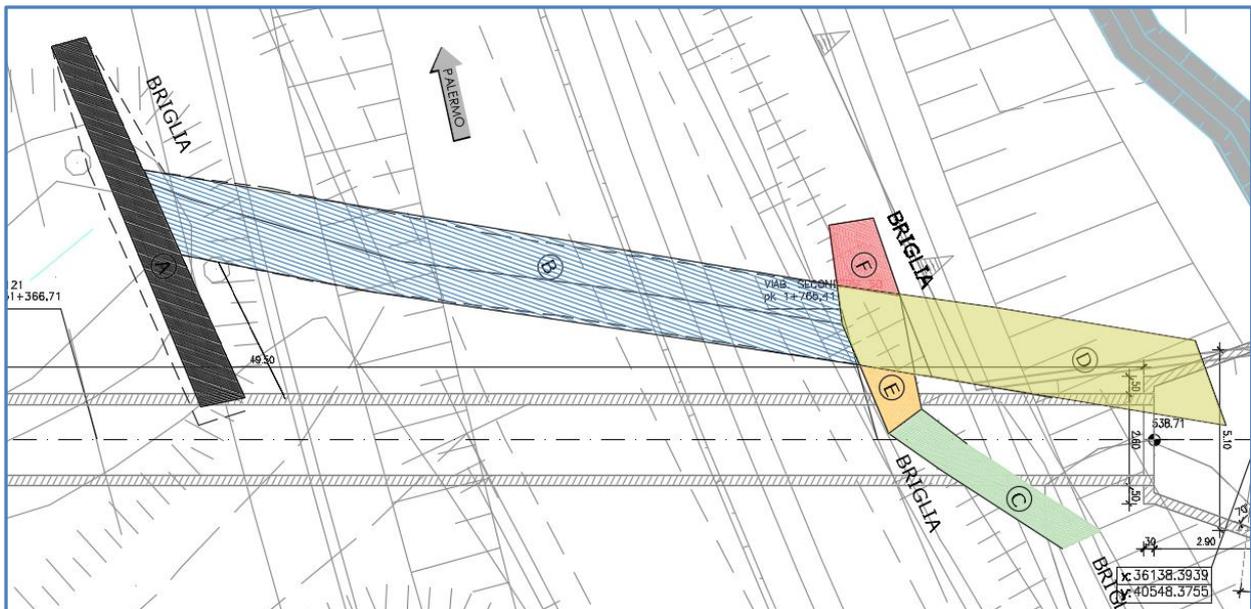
Stralcio planimetrico Tombino idraulico TP68 con posizionamento manufatti in c.a. esistenti.
